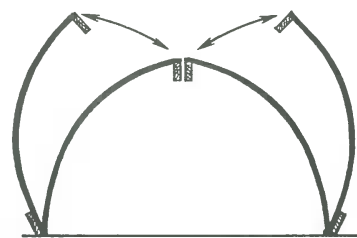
Шарниры на досках основания обеспечивают раскрытие теплицы для вентиляции.
